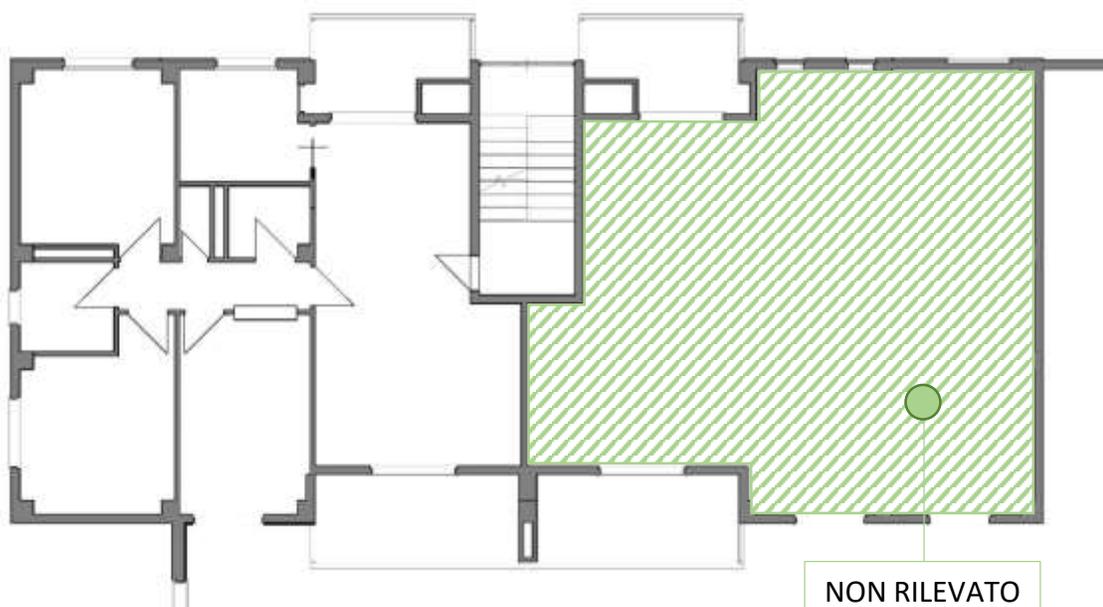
CASO STUDIO - PIANTA DEL PIANO SECONDO
